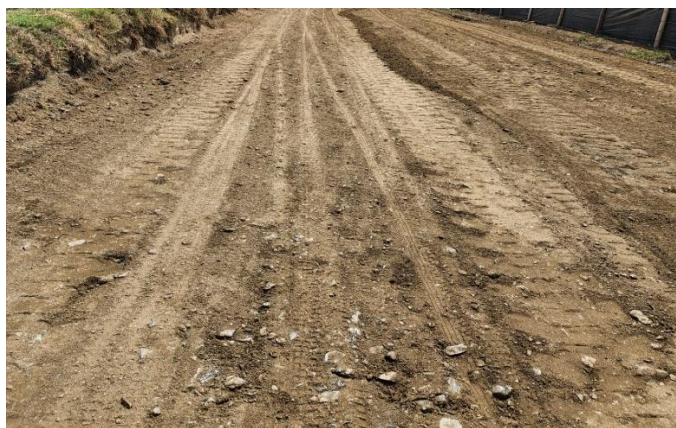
Calle no pavimentada en el centro poblado Santa Casa
